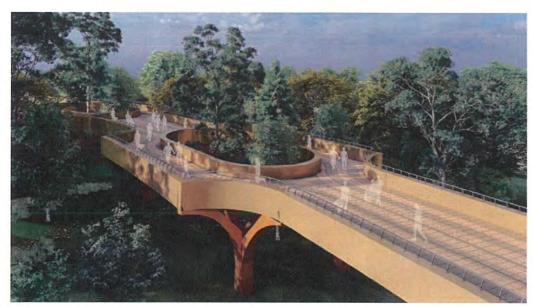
Vista en 3D de Calzada Peatonal Chivatito. Se observan vigas longitudinales como soporte del barandal.
